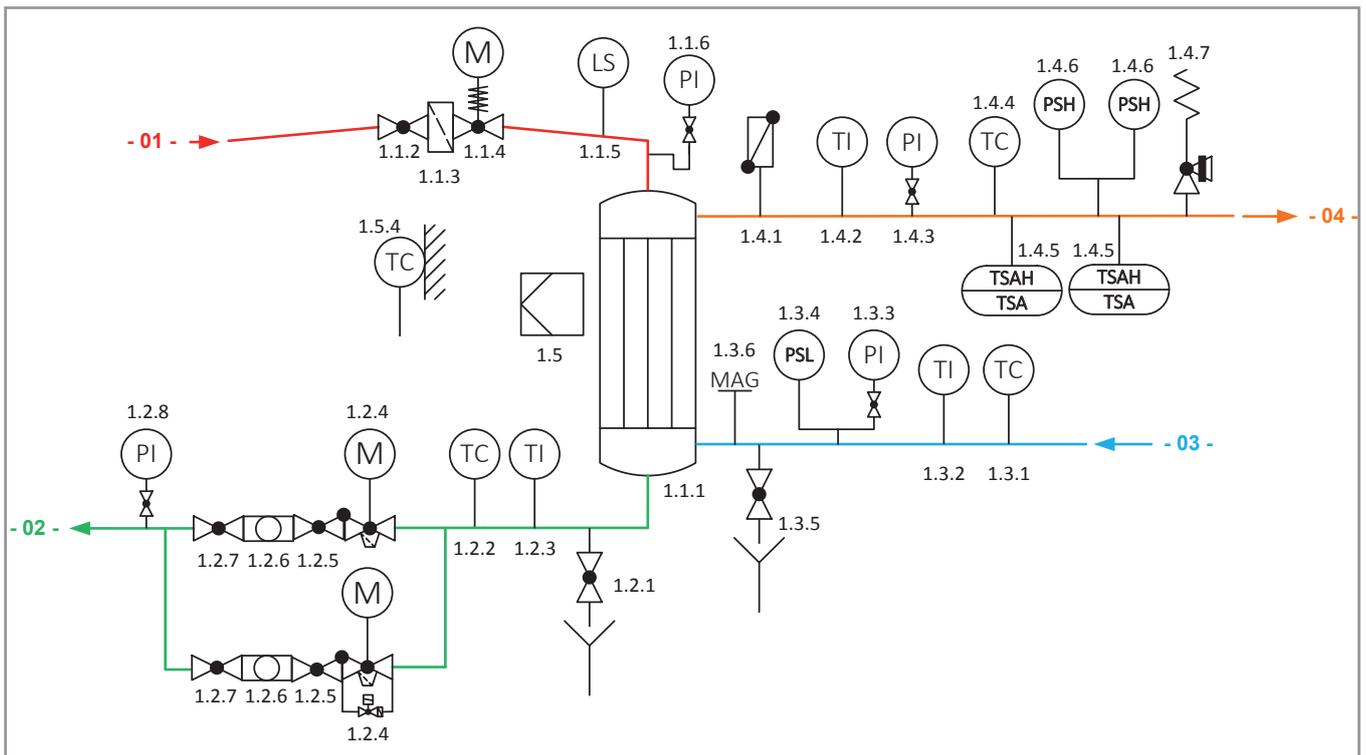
Exemple de schéma d'installation : 750 kW - 1300 kW (≥ 3 bar)
